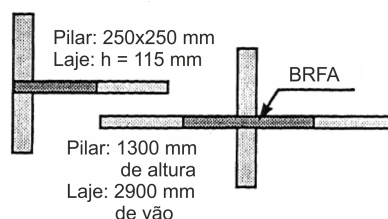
Configuração das ligações interiores e de bordo utilizadas por Diaz (adaptado de [37]).
